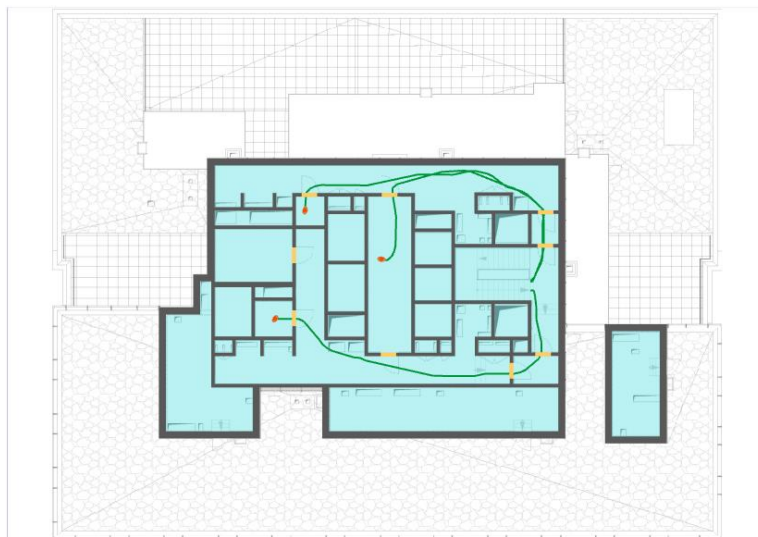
План техэтажа на отм. +116.250 и нанесенная на него расчетная (принципиальная) схема эвакуации
